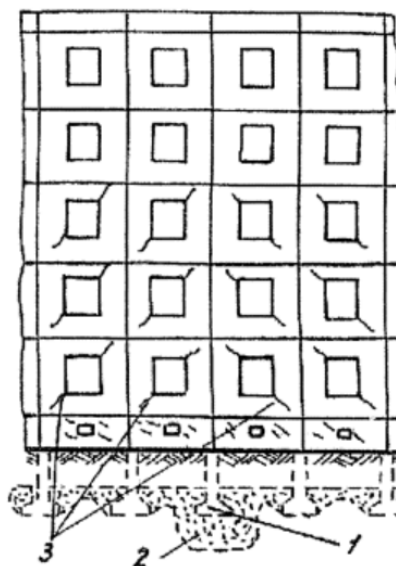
Схема трещин в стене крупнопанельного здания от неравномерной осадки фундаментов:
